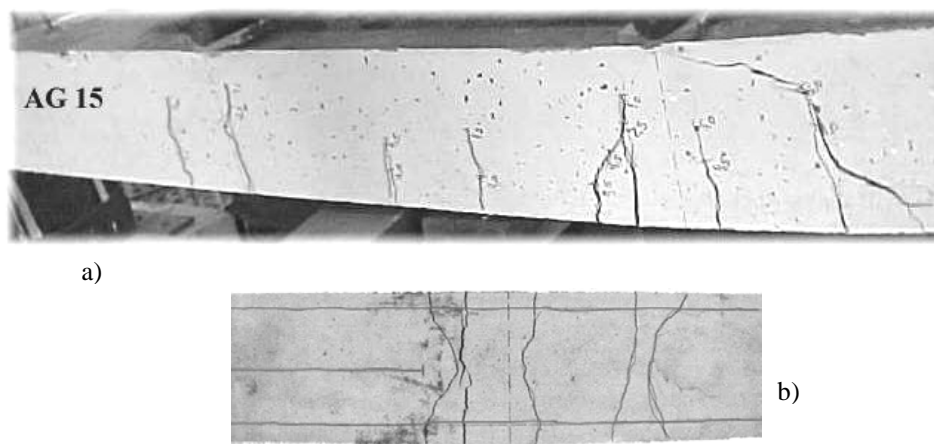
Viga AG 15 – a) vista lateral- b) vista da ruptura de fundo.
